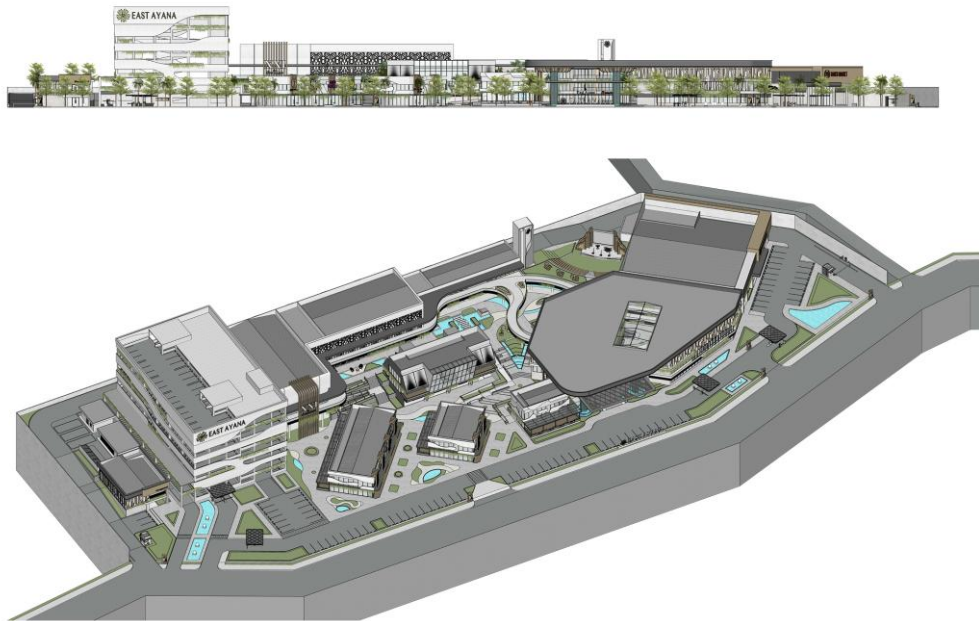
Aplikasi Bentuk Massa Bangunan
